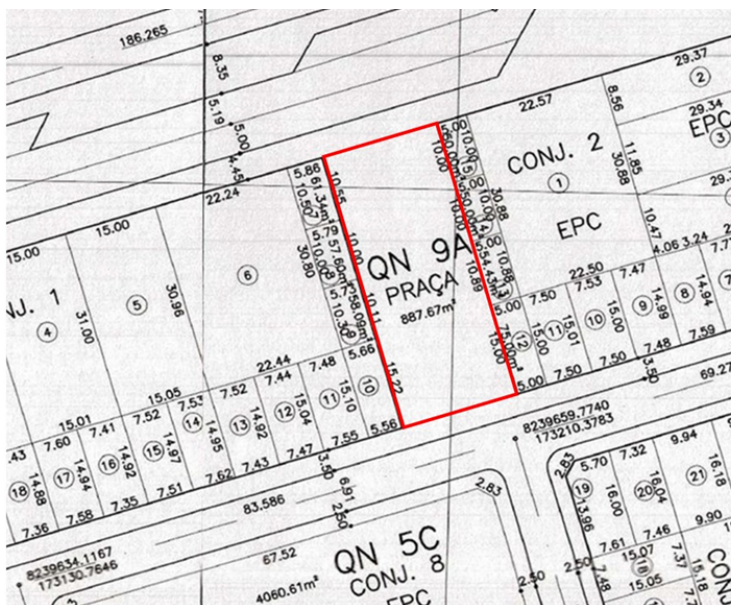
Recorte Projeto de Urbanismo – URB 002/1, com a localização da Praça da QN 9A do Riacho Fundo II. Fonte. Mapoteca/GDF
